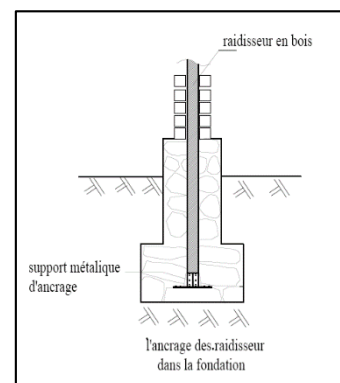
Rattachement des murs avec fondation (Source : auteur)
